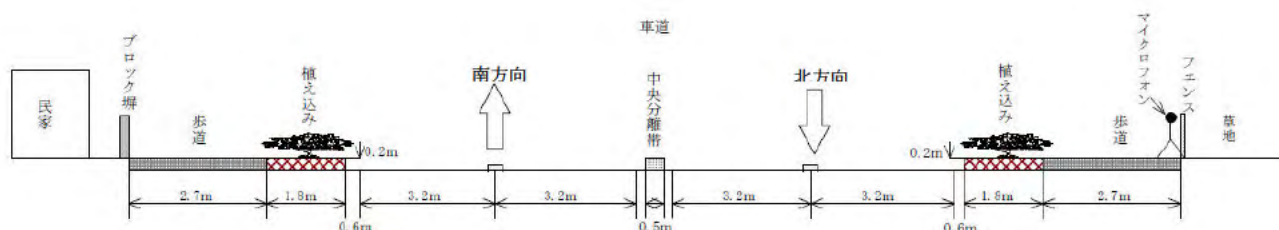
st. 2'の詳細図及び道路断面図
